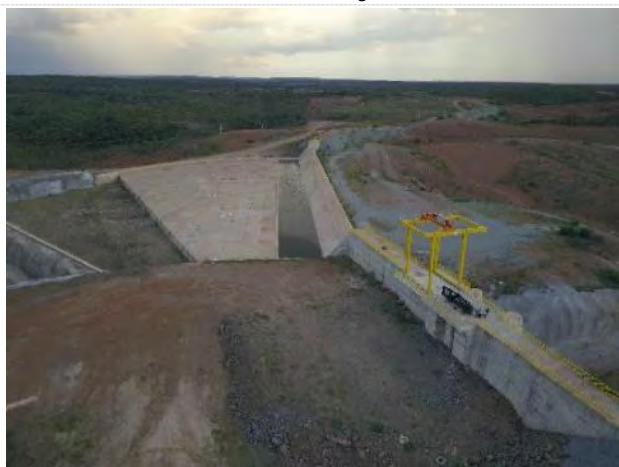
Barragem Jati - Torre da TUD – Barragem Jati -
